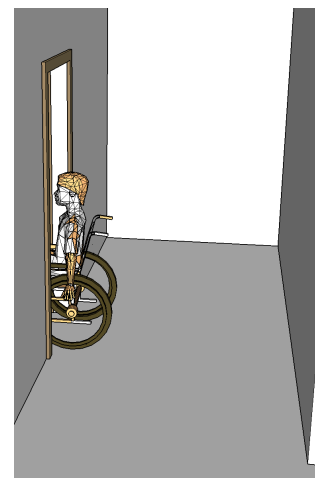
Barreiras não encontradas na circulação do pavimento tipo residencial. Fonte: autora, 2016.
